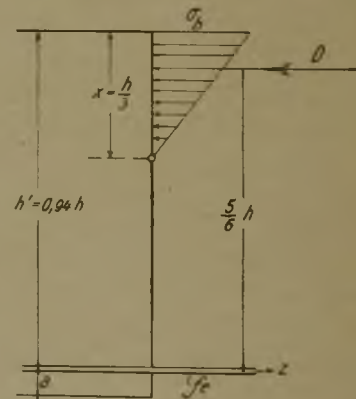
Eisenbetonquerschnitt mit einfacher Bewehrung bei reiner Biegung.
